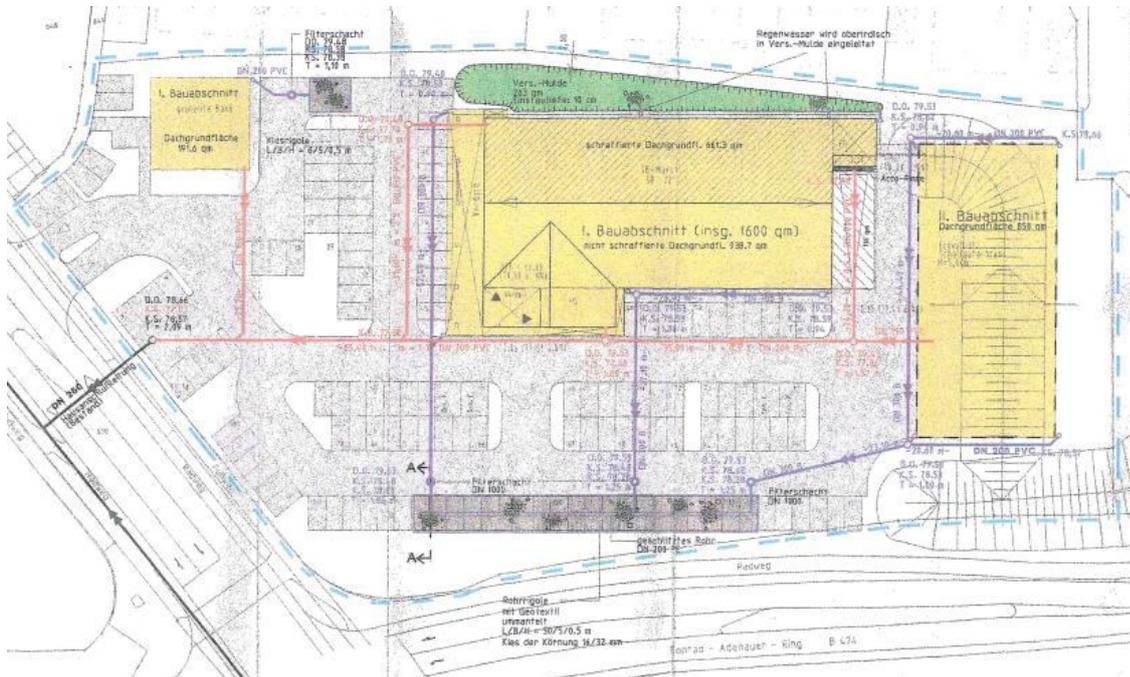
Lageplan zum Entwässerungsantrag 01/2000
